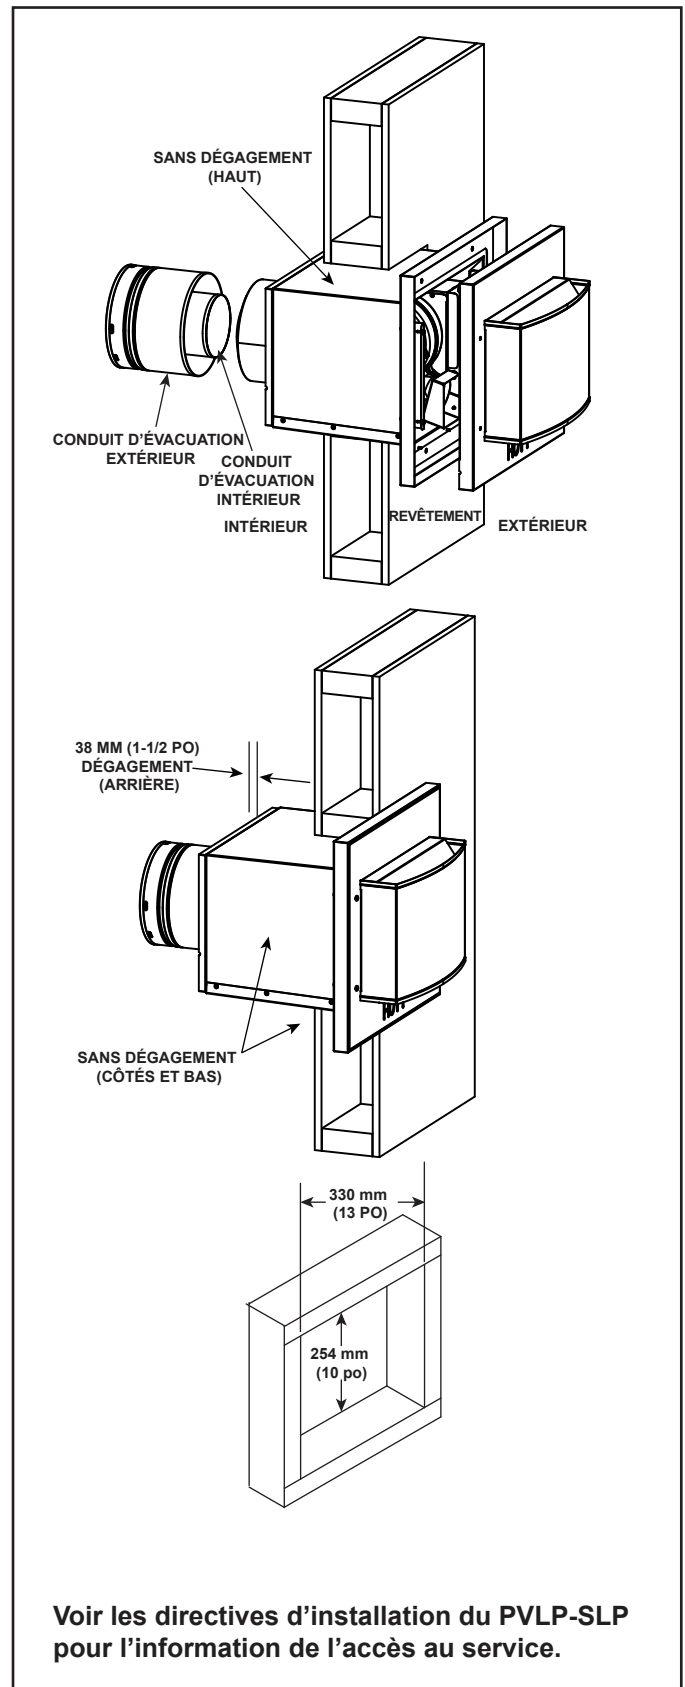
Conduit d'évacuation traversant le mur - PVLP-SLP
